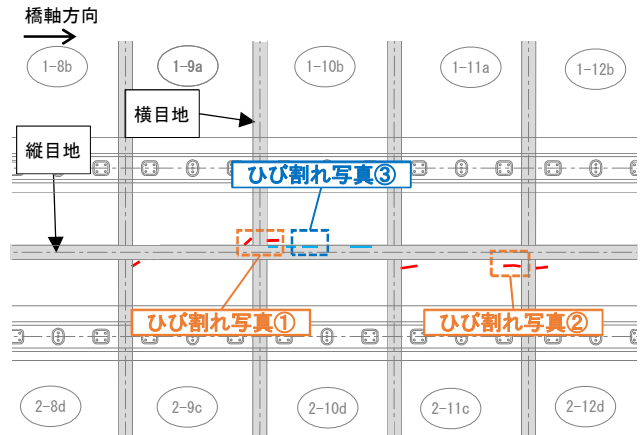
ひび割れ発生状況（PCaPC床版底面）
